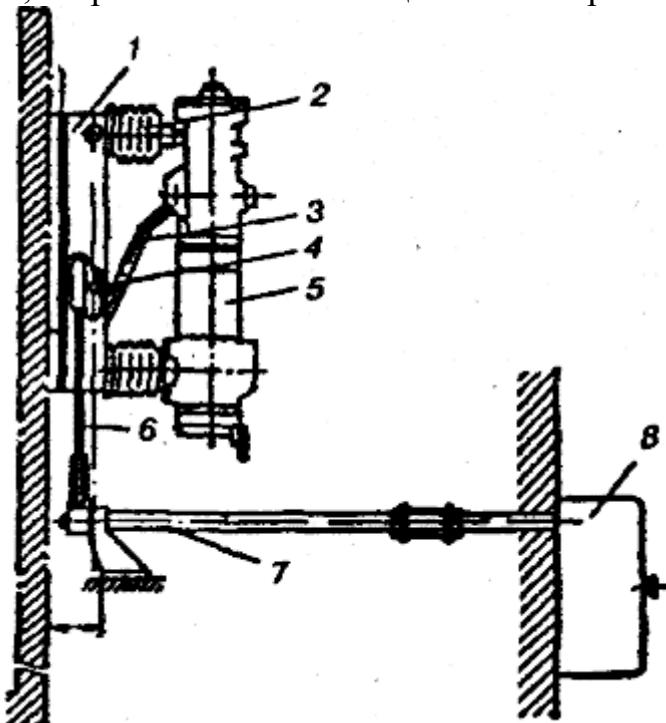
Внешний вид выключателя с приводом типа ПЭ-11
